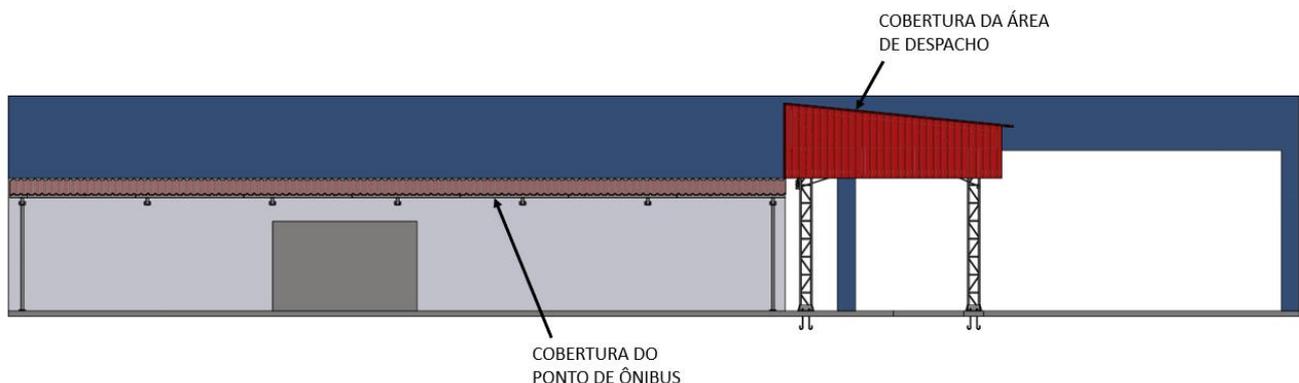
Esquema, em vista frontal, da edificação junto das novas coberturas
